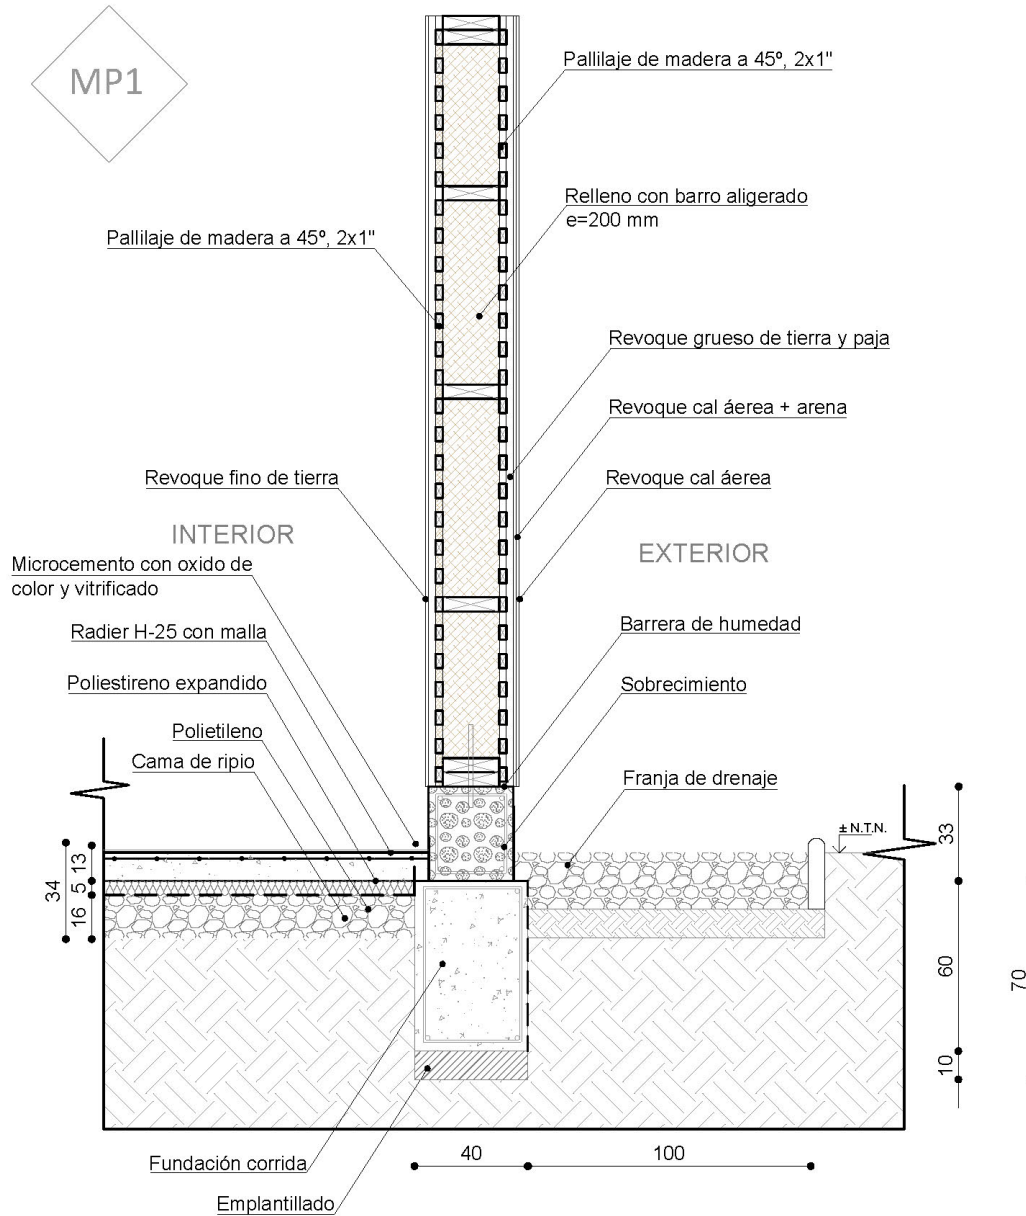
Detalle constructivo tipo de la estructura en quincha de proyecto. Elaboración propia.
